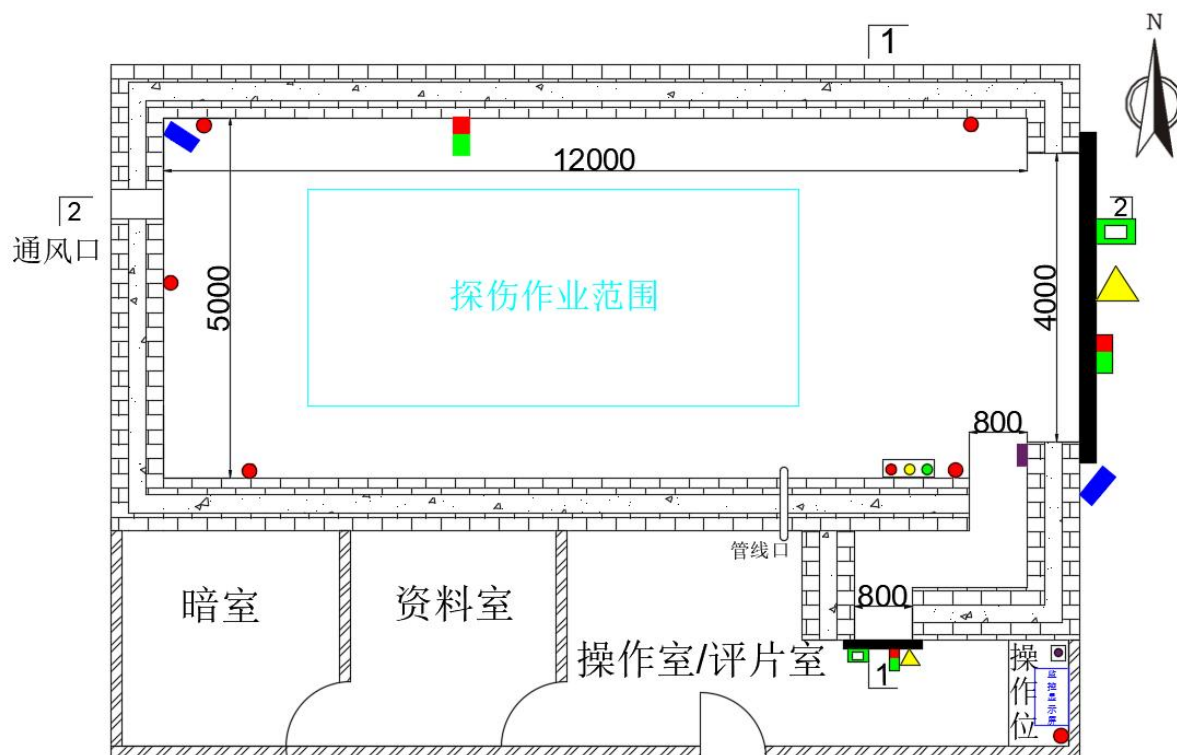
(a) X 射线探伤机在探伤室内探伤作业范围示意图（平面图，单位：mm）
